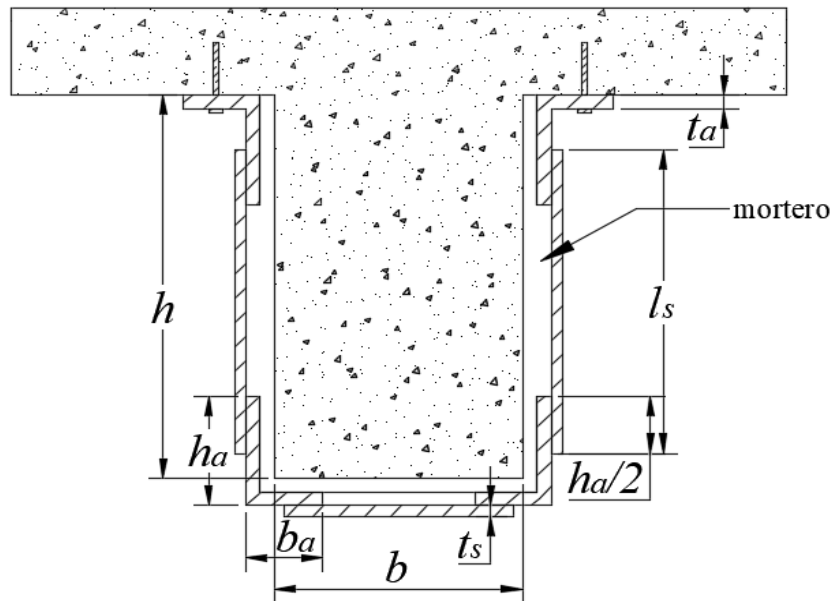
Sección transversal de viga encamisada con ángulos y soleras
